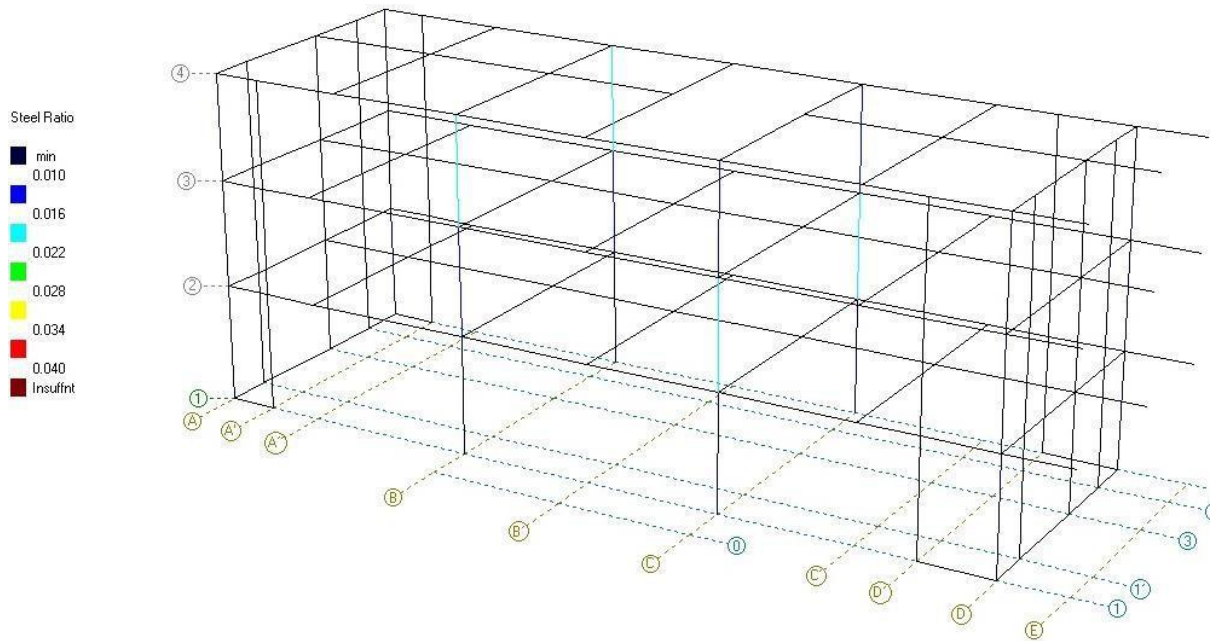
Sobreesfuerzos en las columnas ya reforzadas. Elaborada por el autor.
